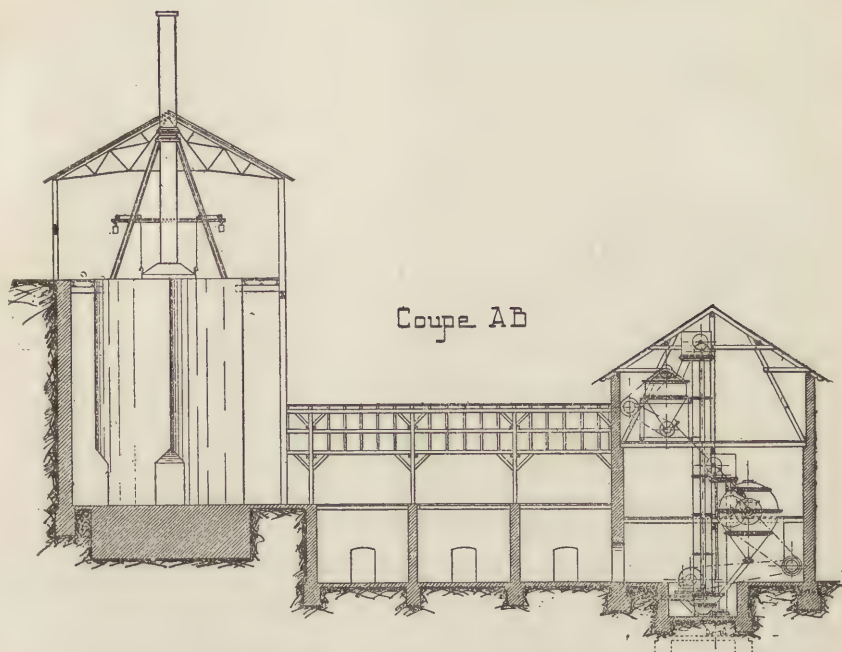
Fabrique de ciment et chaux hydraulique de Guérigny.
